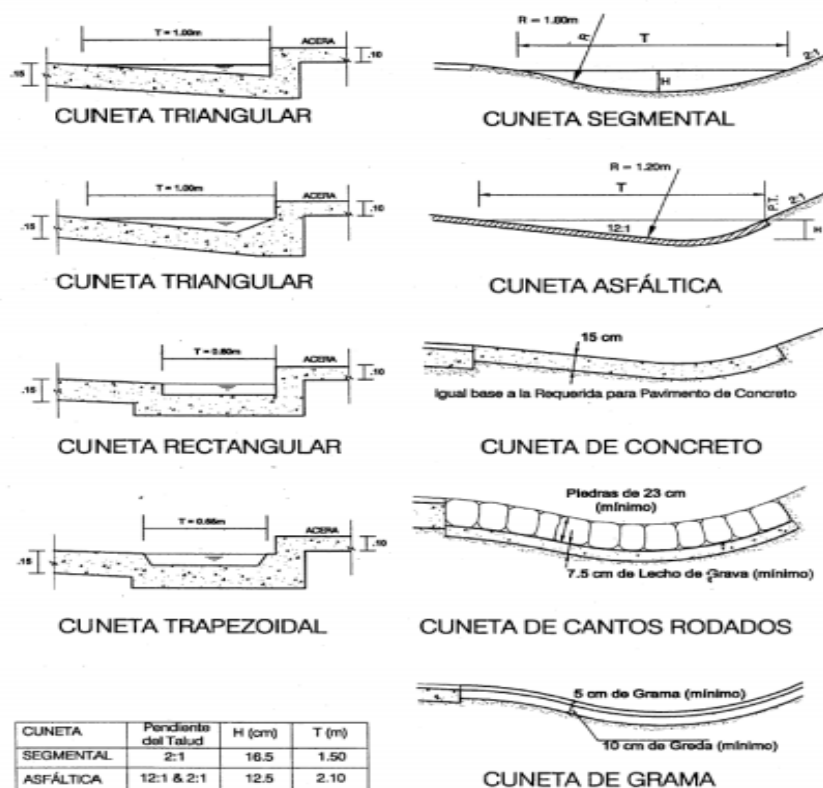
Sección transversal de cunetas Fuente: Partes Específicas del Sistema de Alcantarillado de Aguas Lluvias, Ponencia de Abastecimiento de Agua y Alcantarillado, año 2009.
